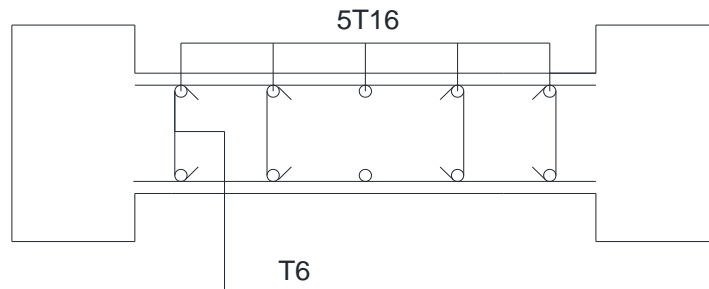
Schéma de ferrailage du voile (poutres noyées – bâtiment R+3)
